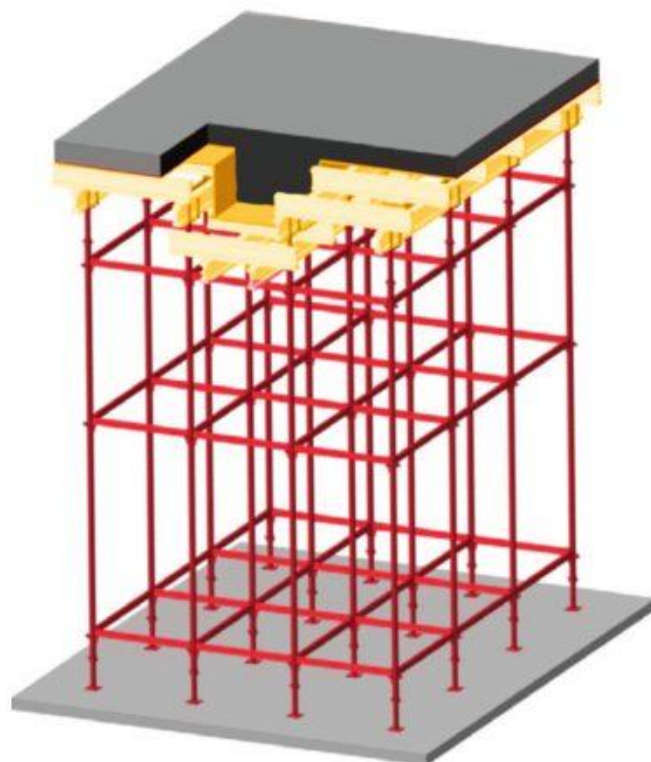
Одновременное формирование монолитного перекрытия и ж/б ригеля с помощью системы объемных стоек
